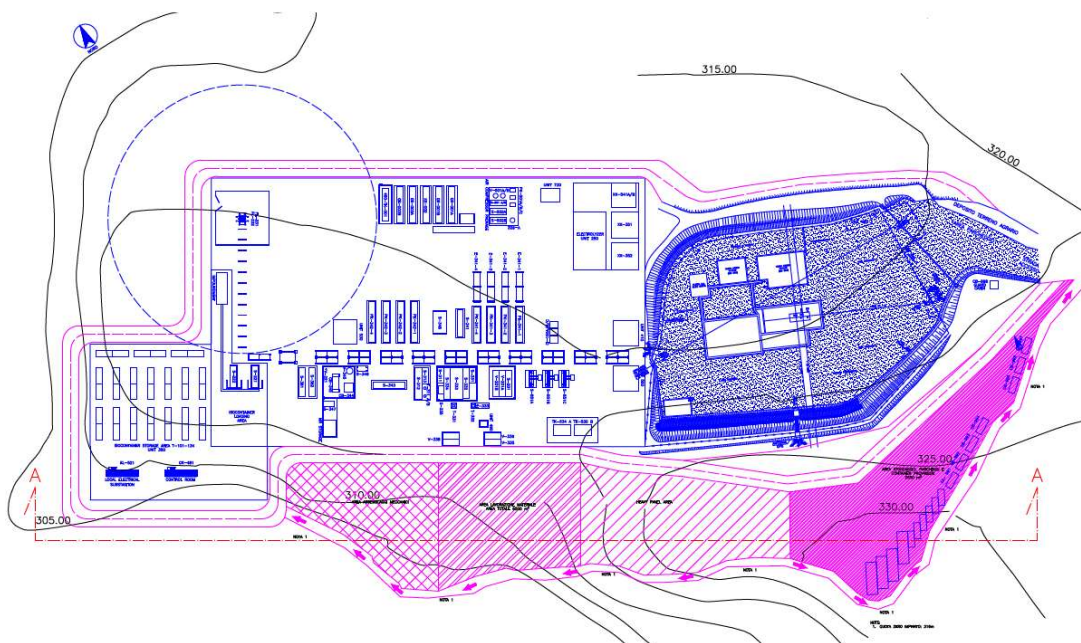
PLANIMETRIA DELL'IMPIANTO, DELL'AREA DI COSTRUZIONE E VIABILITÀ INTERNA
